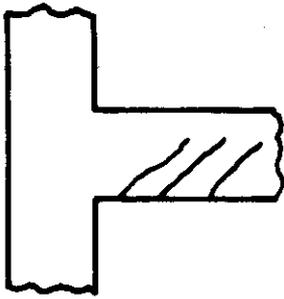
a: Daños en vigas por grietas diagonales
